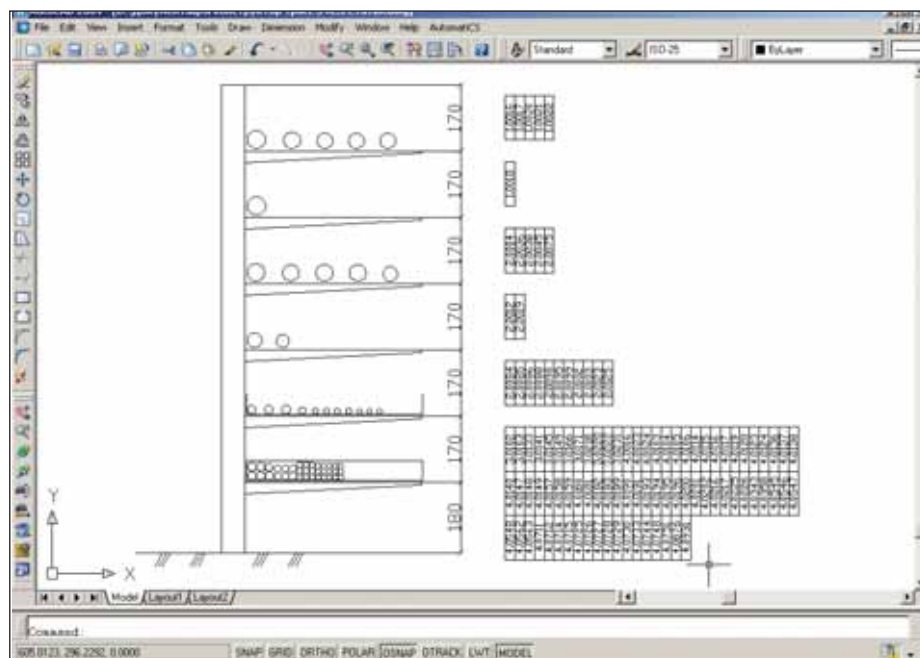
Результат вывода кабельных конструкций и позиций кабелей на план
